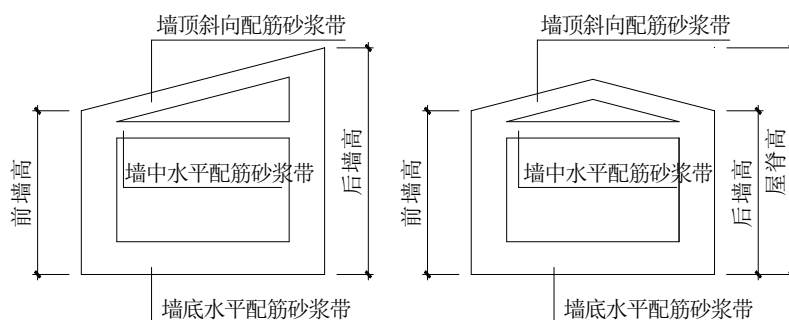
山墙水平配筋砂浆带的布置示意图（内横墙做法可参照此法）
